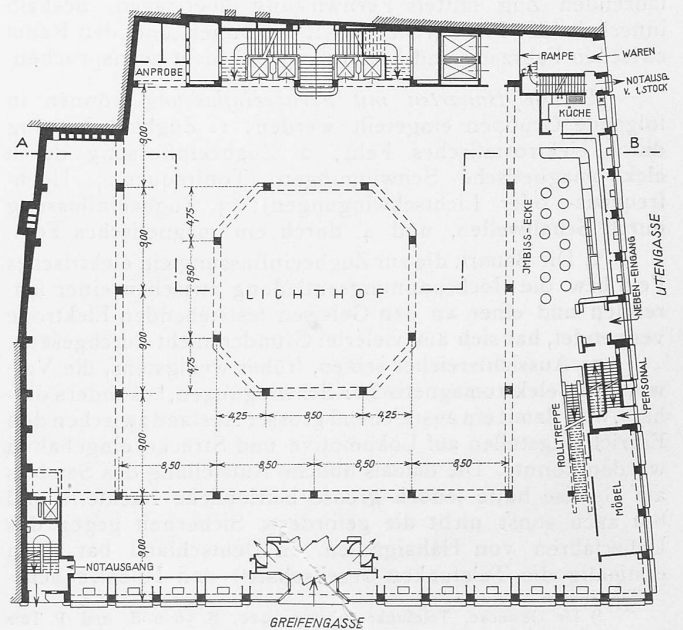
Erdgeschoss. — Masstab 1 : 600.
